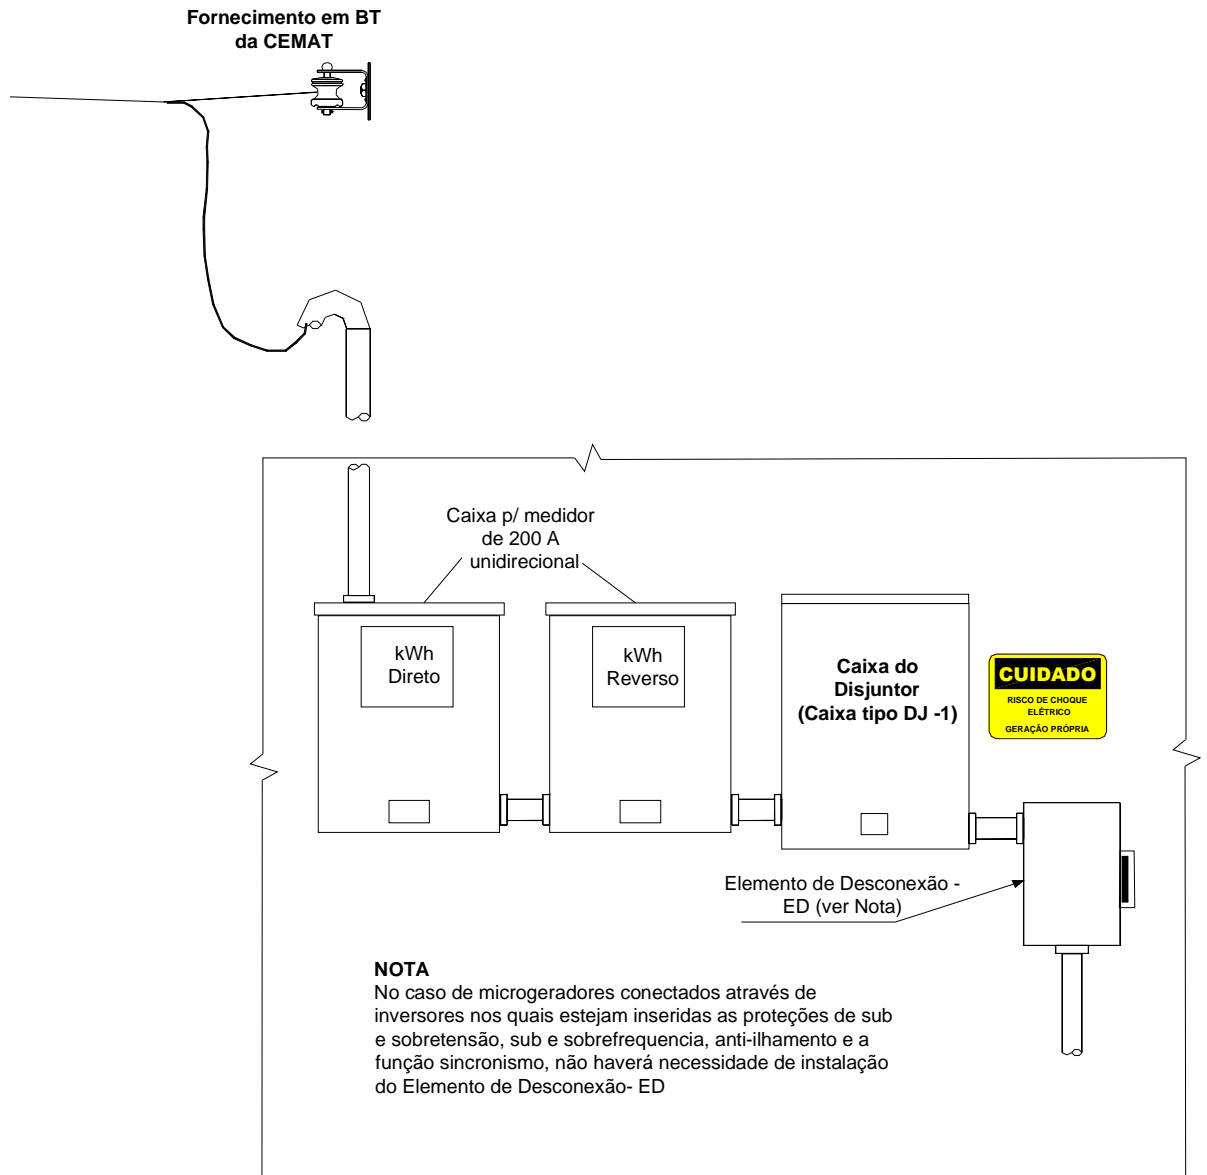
Disposição do Elemento de Desconexão - ED - instalado junto à medição e proteção no padrão de entrada em muro ou mureta - com dois medidores unidirecionais de - 200 A
